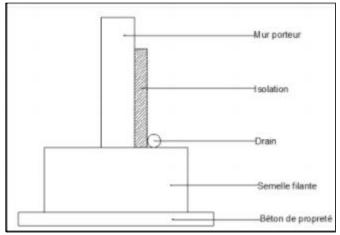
coupe schématique d'une semelle filante Source :http://www.guidebeton.com/fondations-superficielles
